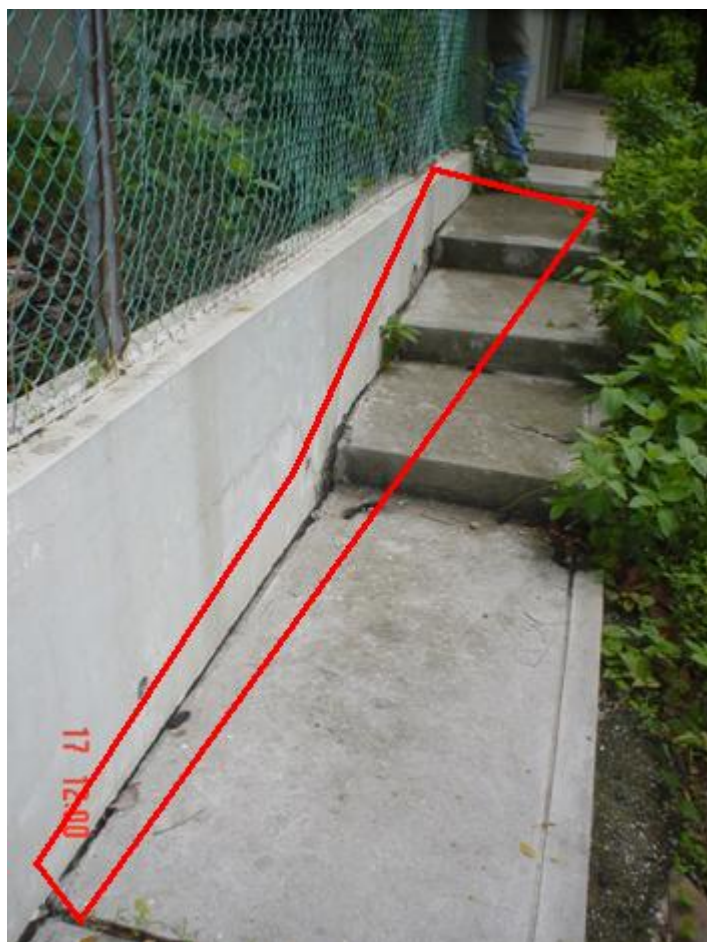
FISURAS Y DETERIORO EN CAMINERAS Y ESCALINATAS
